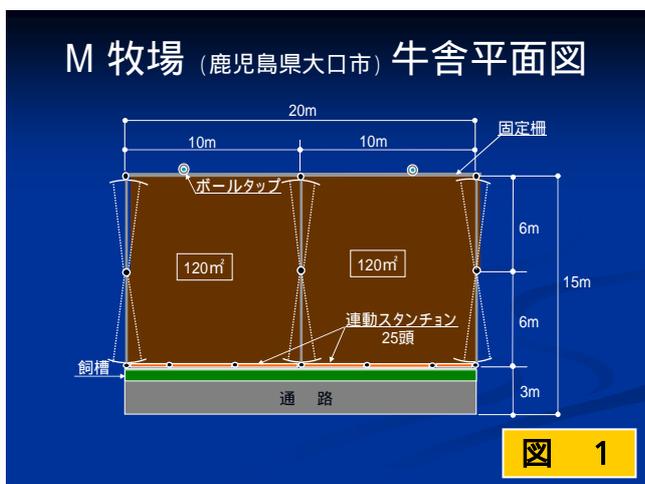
、図 2 は平成 14 年に建設した M 牧場さんの牛舎平面図と立面図です。
